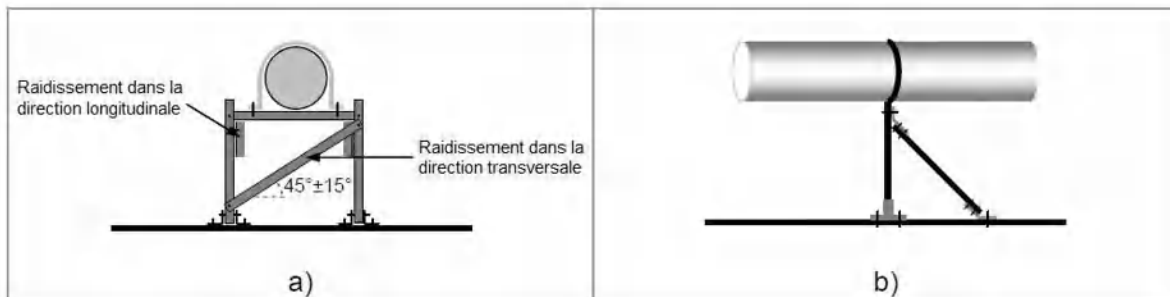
Dispositifs de stabilité pour supports de tuyauteries posés ; a) transversale ; b) longitudinale [R26]
